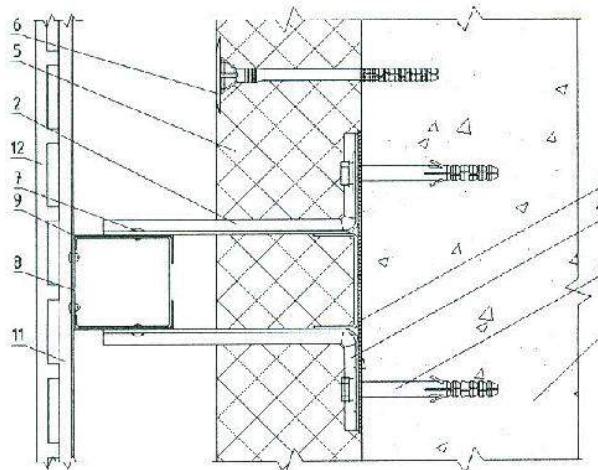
Горизонтальный разрез фасадной системы "АЛЬТ-ФАСАД-10"
